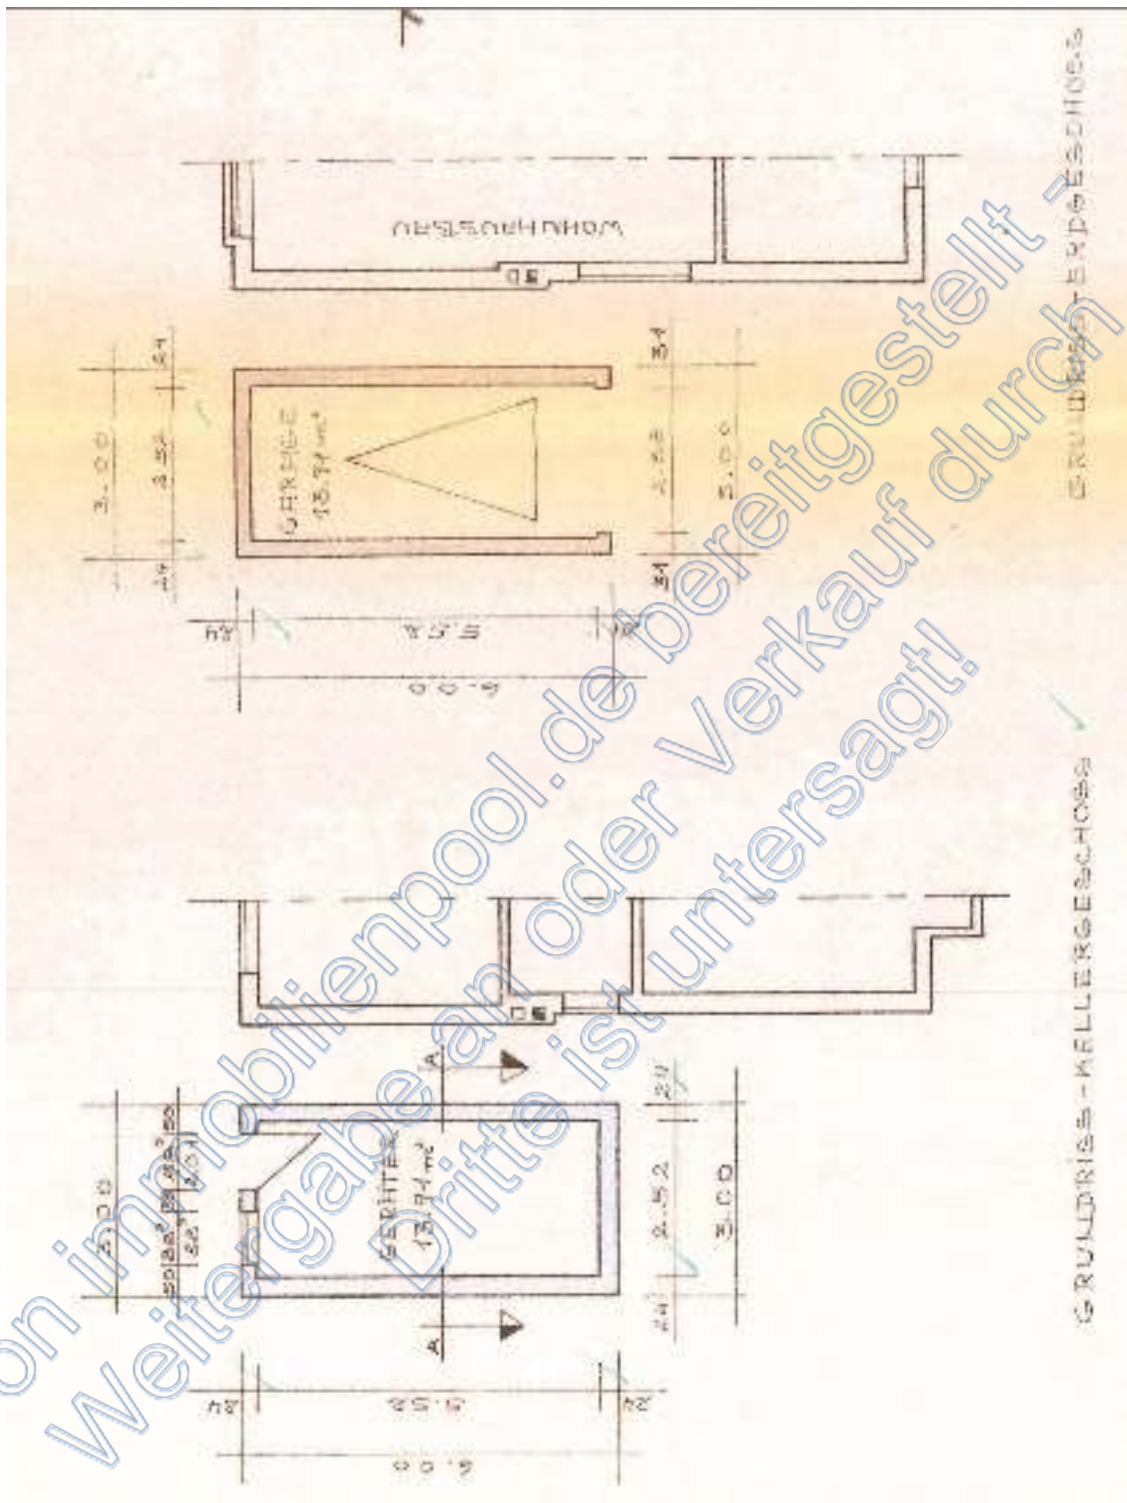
Bauzeichnung - Grundrisse, Garage/Remise
